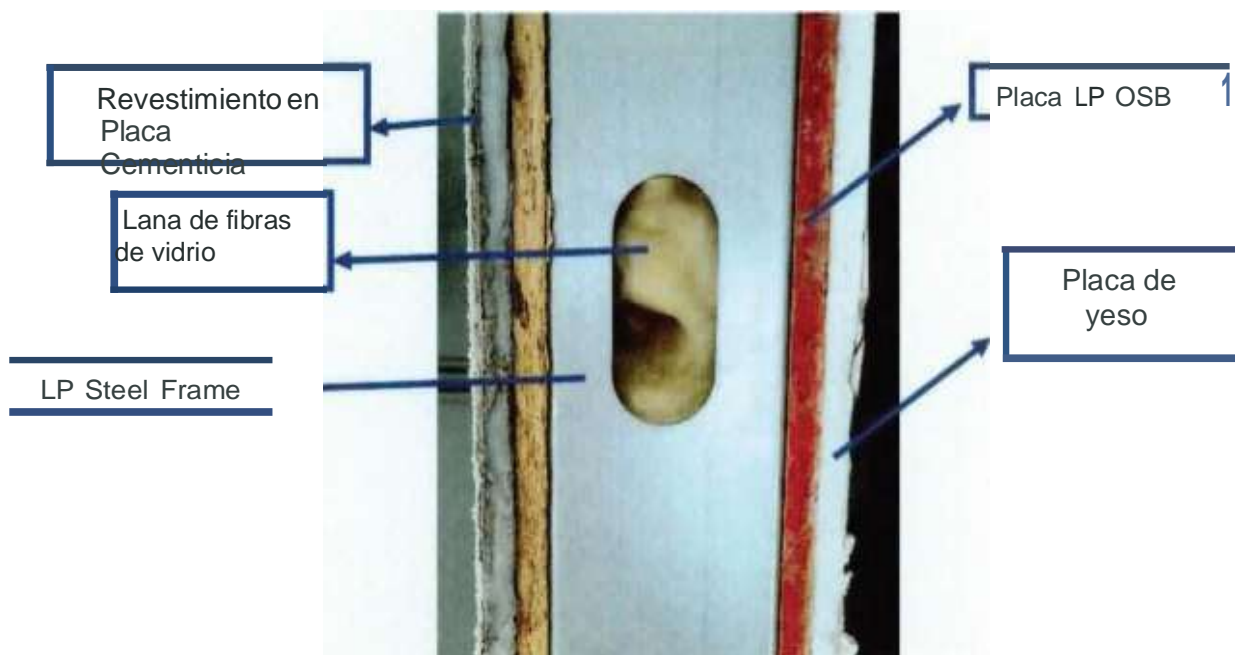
Detalle de las capas del sistema de fachada ensayado.
